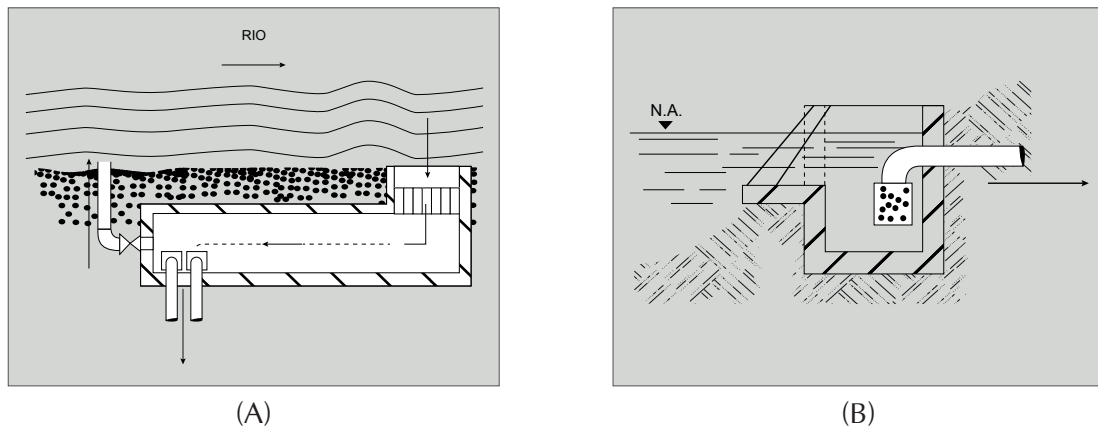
Desvio parcial das águas de um rio em planta (A) e corte (B).
